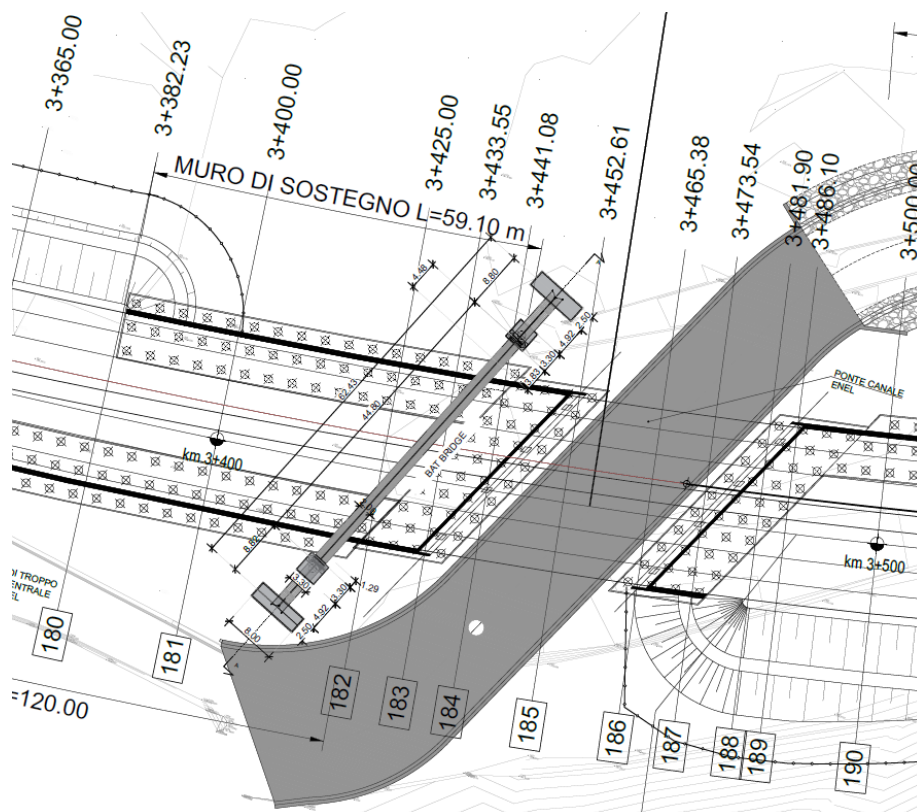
Planimetria di posizionamento del bat-bridge
